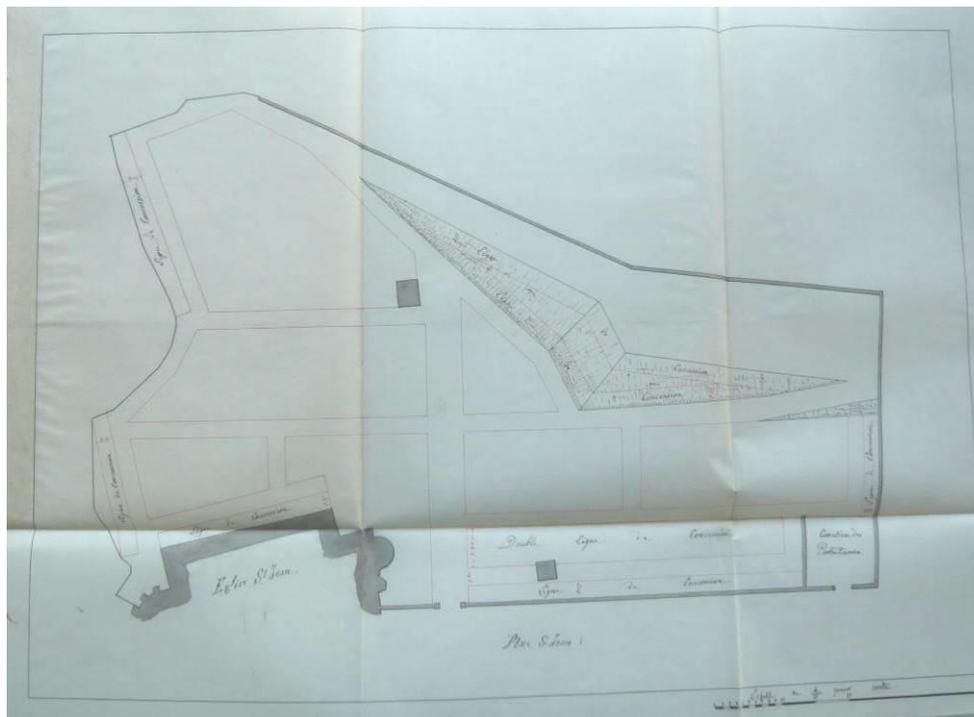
Plan Général du cimetière Saint-Jean, 14 avril 1876, par l'architecte soussigné Lecat. AD 63, 2 O 430/14
